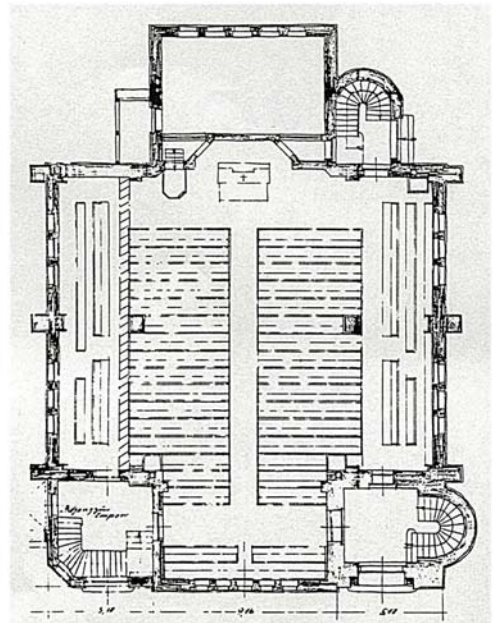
Grundriss, Entwurf Friedrich Adolf Cornehl
